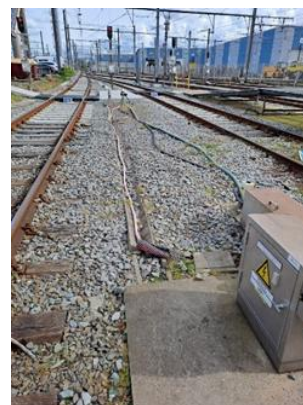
Installations de préchauffage : les câbles d'alimentation
